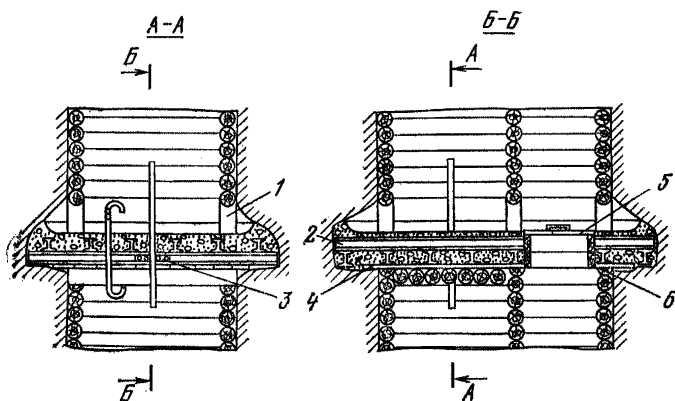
Железобетонная перемычка для наклонных и вертикальных выработок
